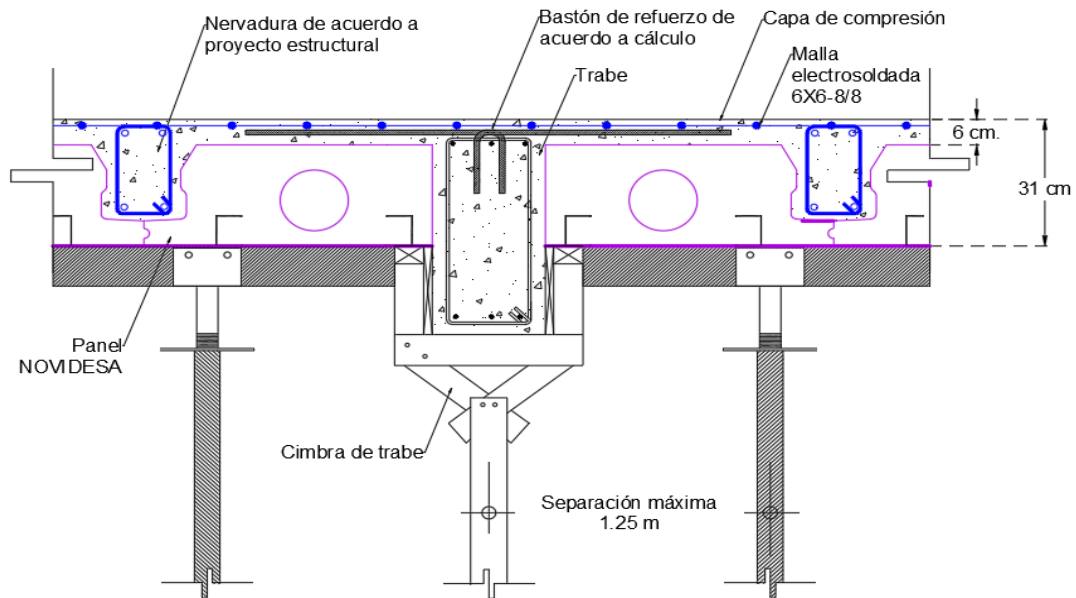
Detalle en corte transversal del sistema de entepiso con panel de poliestireno. (Área Técnica Novidesa, 2010)
